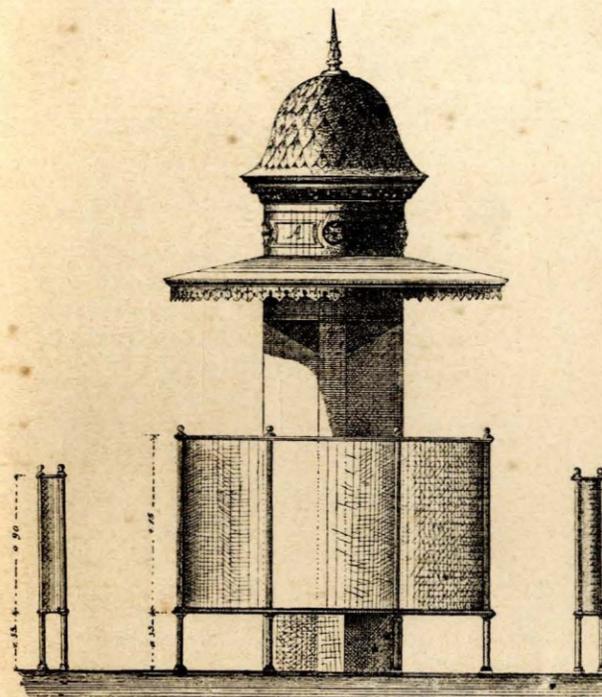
e 6 — Prospetto e pianta dell'orinatoio, colonna in muratura.
